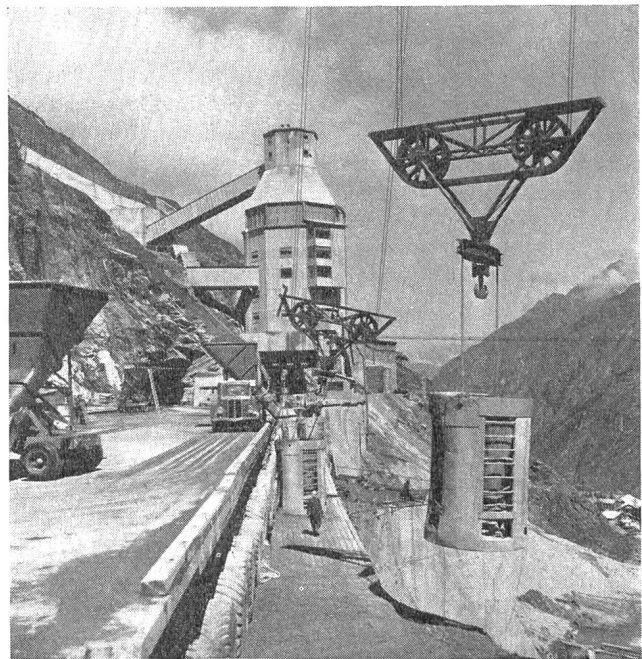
Betonturm Staumauer Mauvoisin, ausgerüstet mit 5 Kippmischern à 3 m<sup>3</sup> fertigen Beton, Stundenleistung 300 m<sup>3</sup>; Entleeren des Betons vom Silobus in die Betonkübel 6 m<sup>3</sup>
